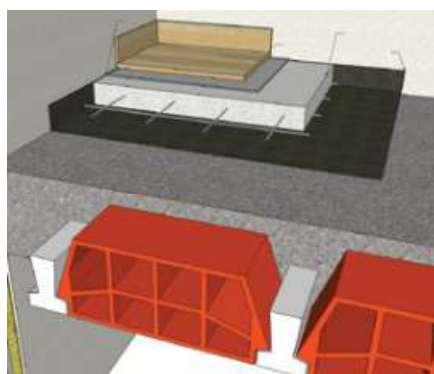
Dettaglio di un tipico sistema di pavimento galleggiante su solaio in laterocemento realizzato in Spagna - Detail of a typical floating floor realized in Spain [5]
